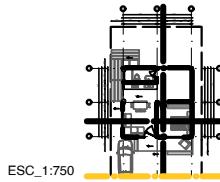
[Figura] tipología 1 de prototipo de vivienda con el sistema constructivo bahareque encementado.
